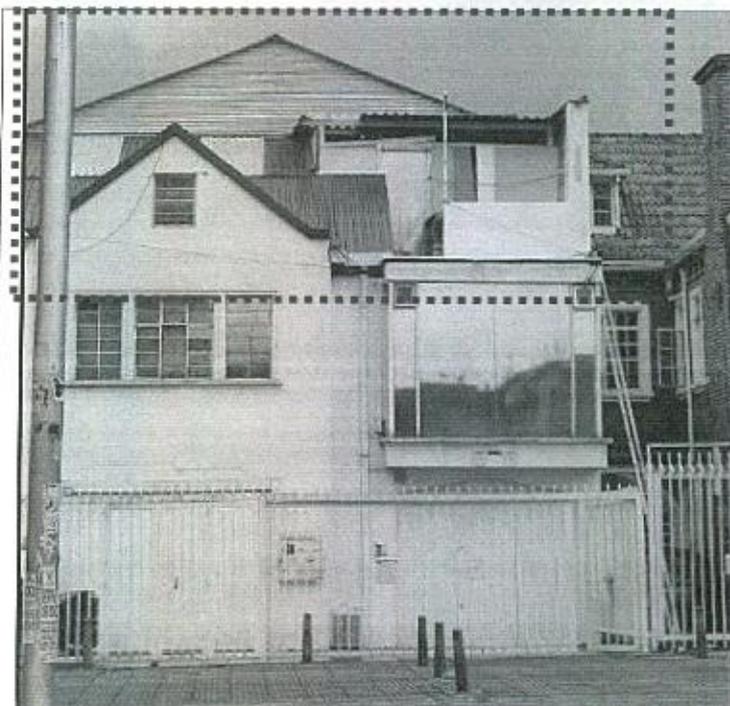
, 2 y 3 - Estado actual de las fachadas CL 57 18 13.
